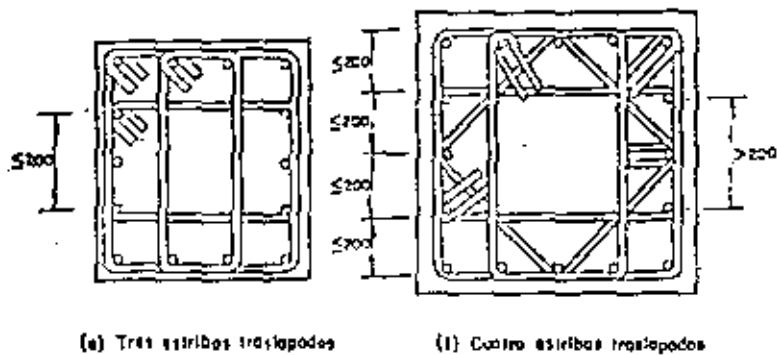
Diversas alternativas de arreglos de estribos y grapas para confinamiento de columnas
